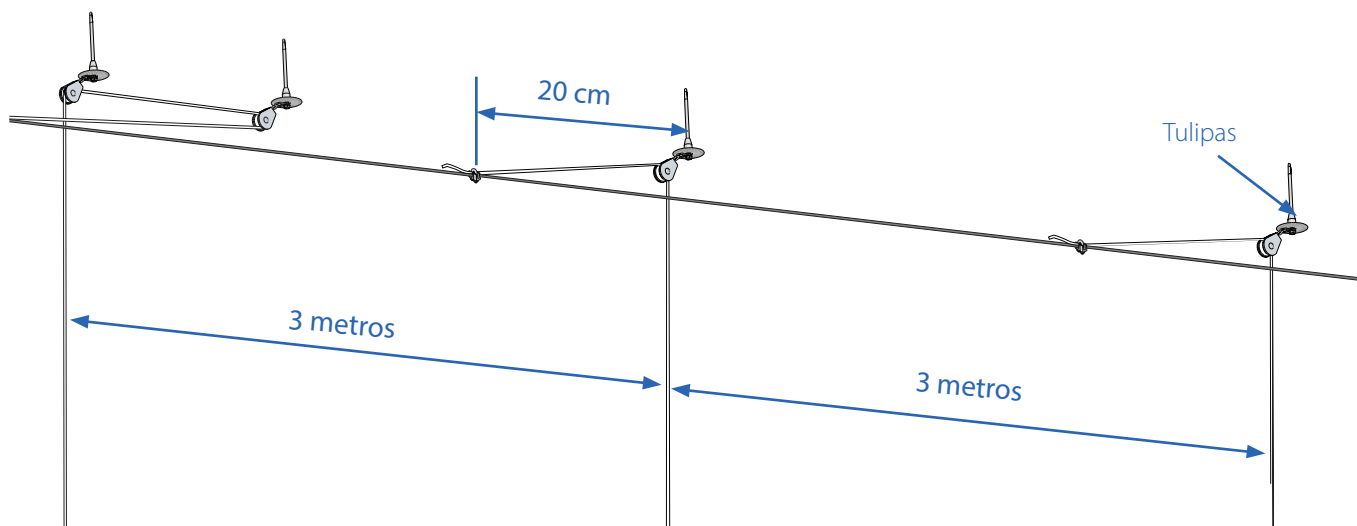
Detalle de la distancia de separación de las TULIPAS.
